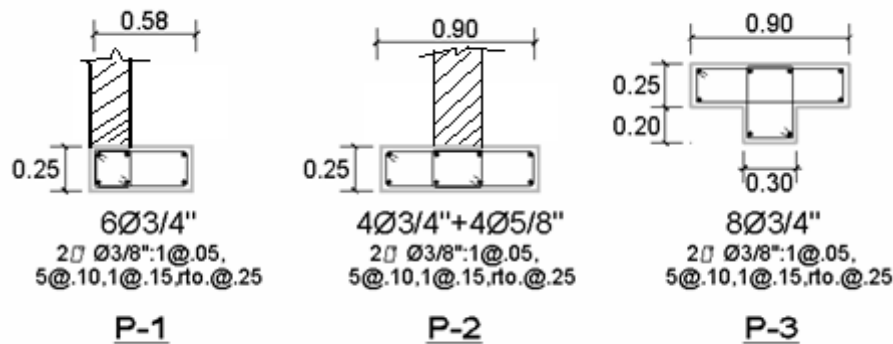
Detalle del refuerzo de las columnas (colegio 780 nuevo)
